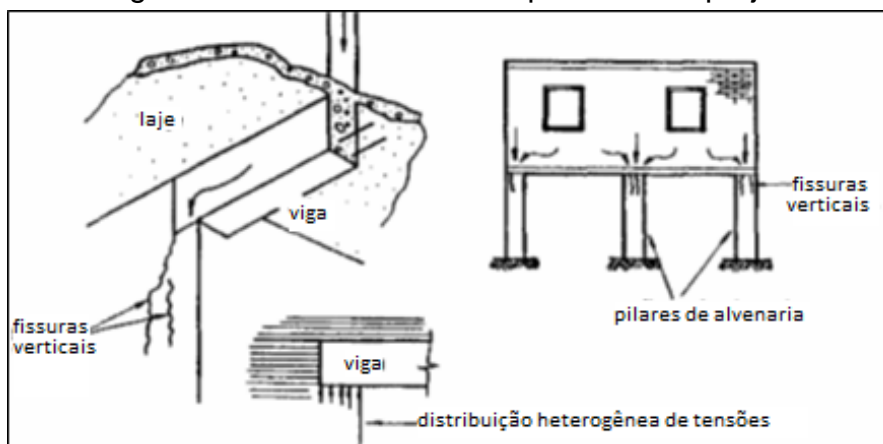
Fissuras devido atuação de sobrecarga
